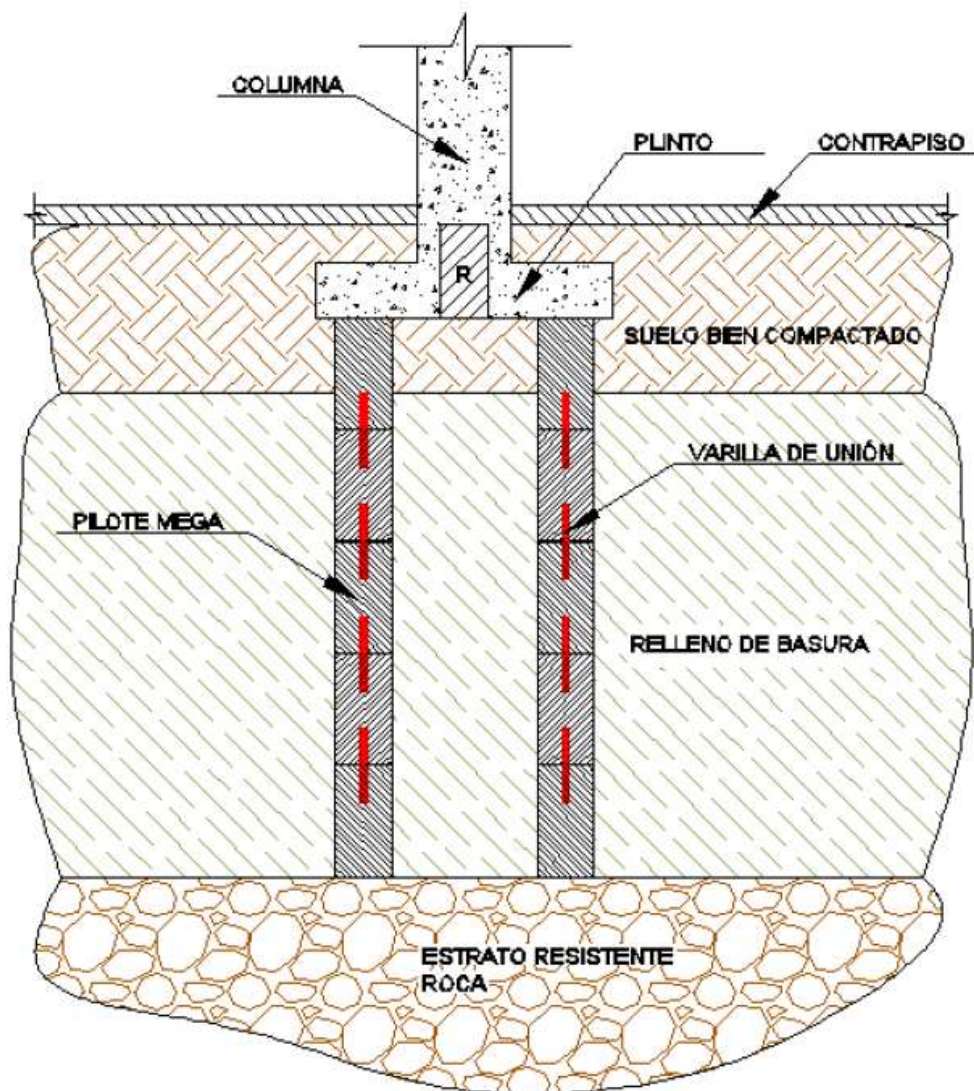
Detalle de Pilotes Mega en cimentación del Edificio de la Facultad de Ingeniería Civil. Fuente: (Loor, 2015)
